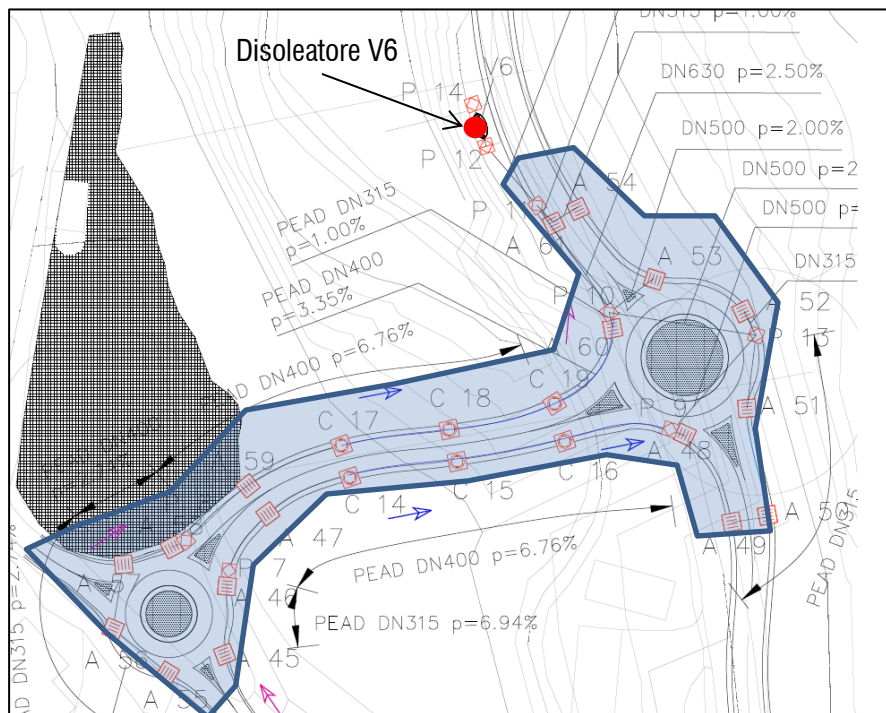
Area di progetto interessata al disoleatore di Rione Borgato.
